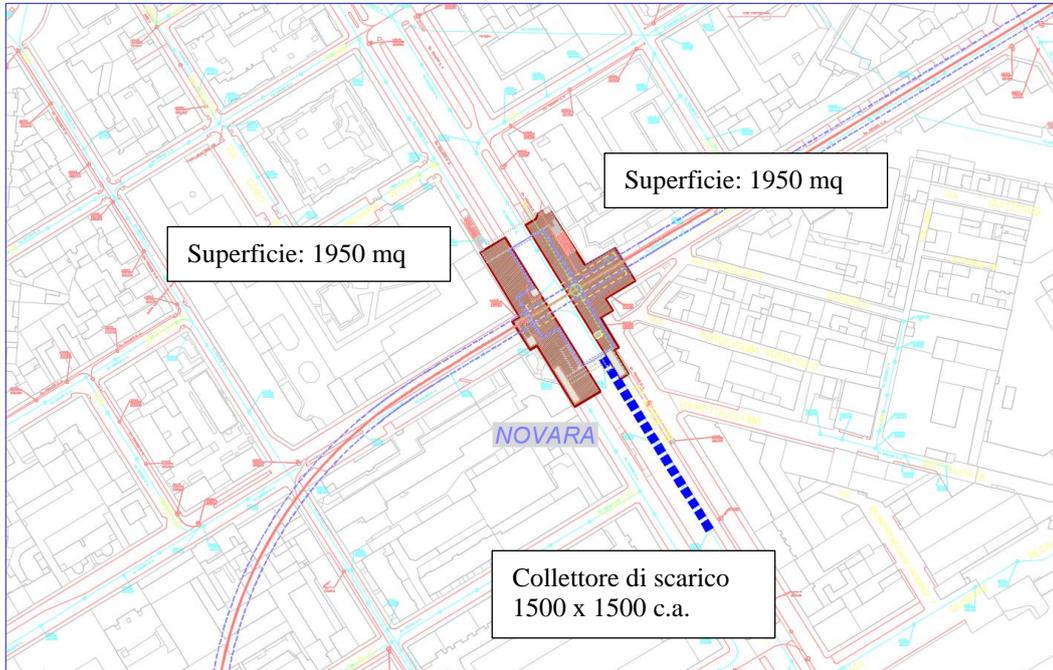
Aree di cantiere – Stazione Novara – FASE 1
